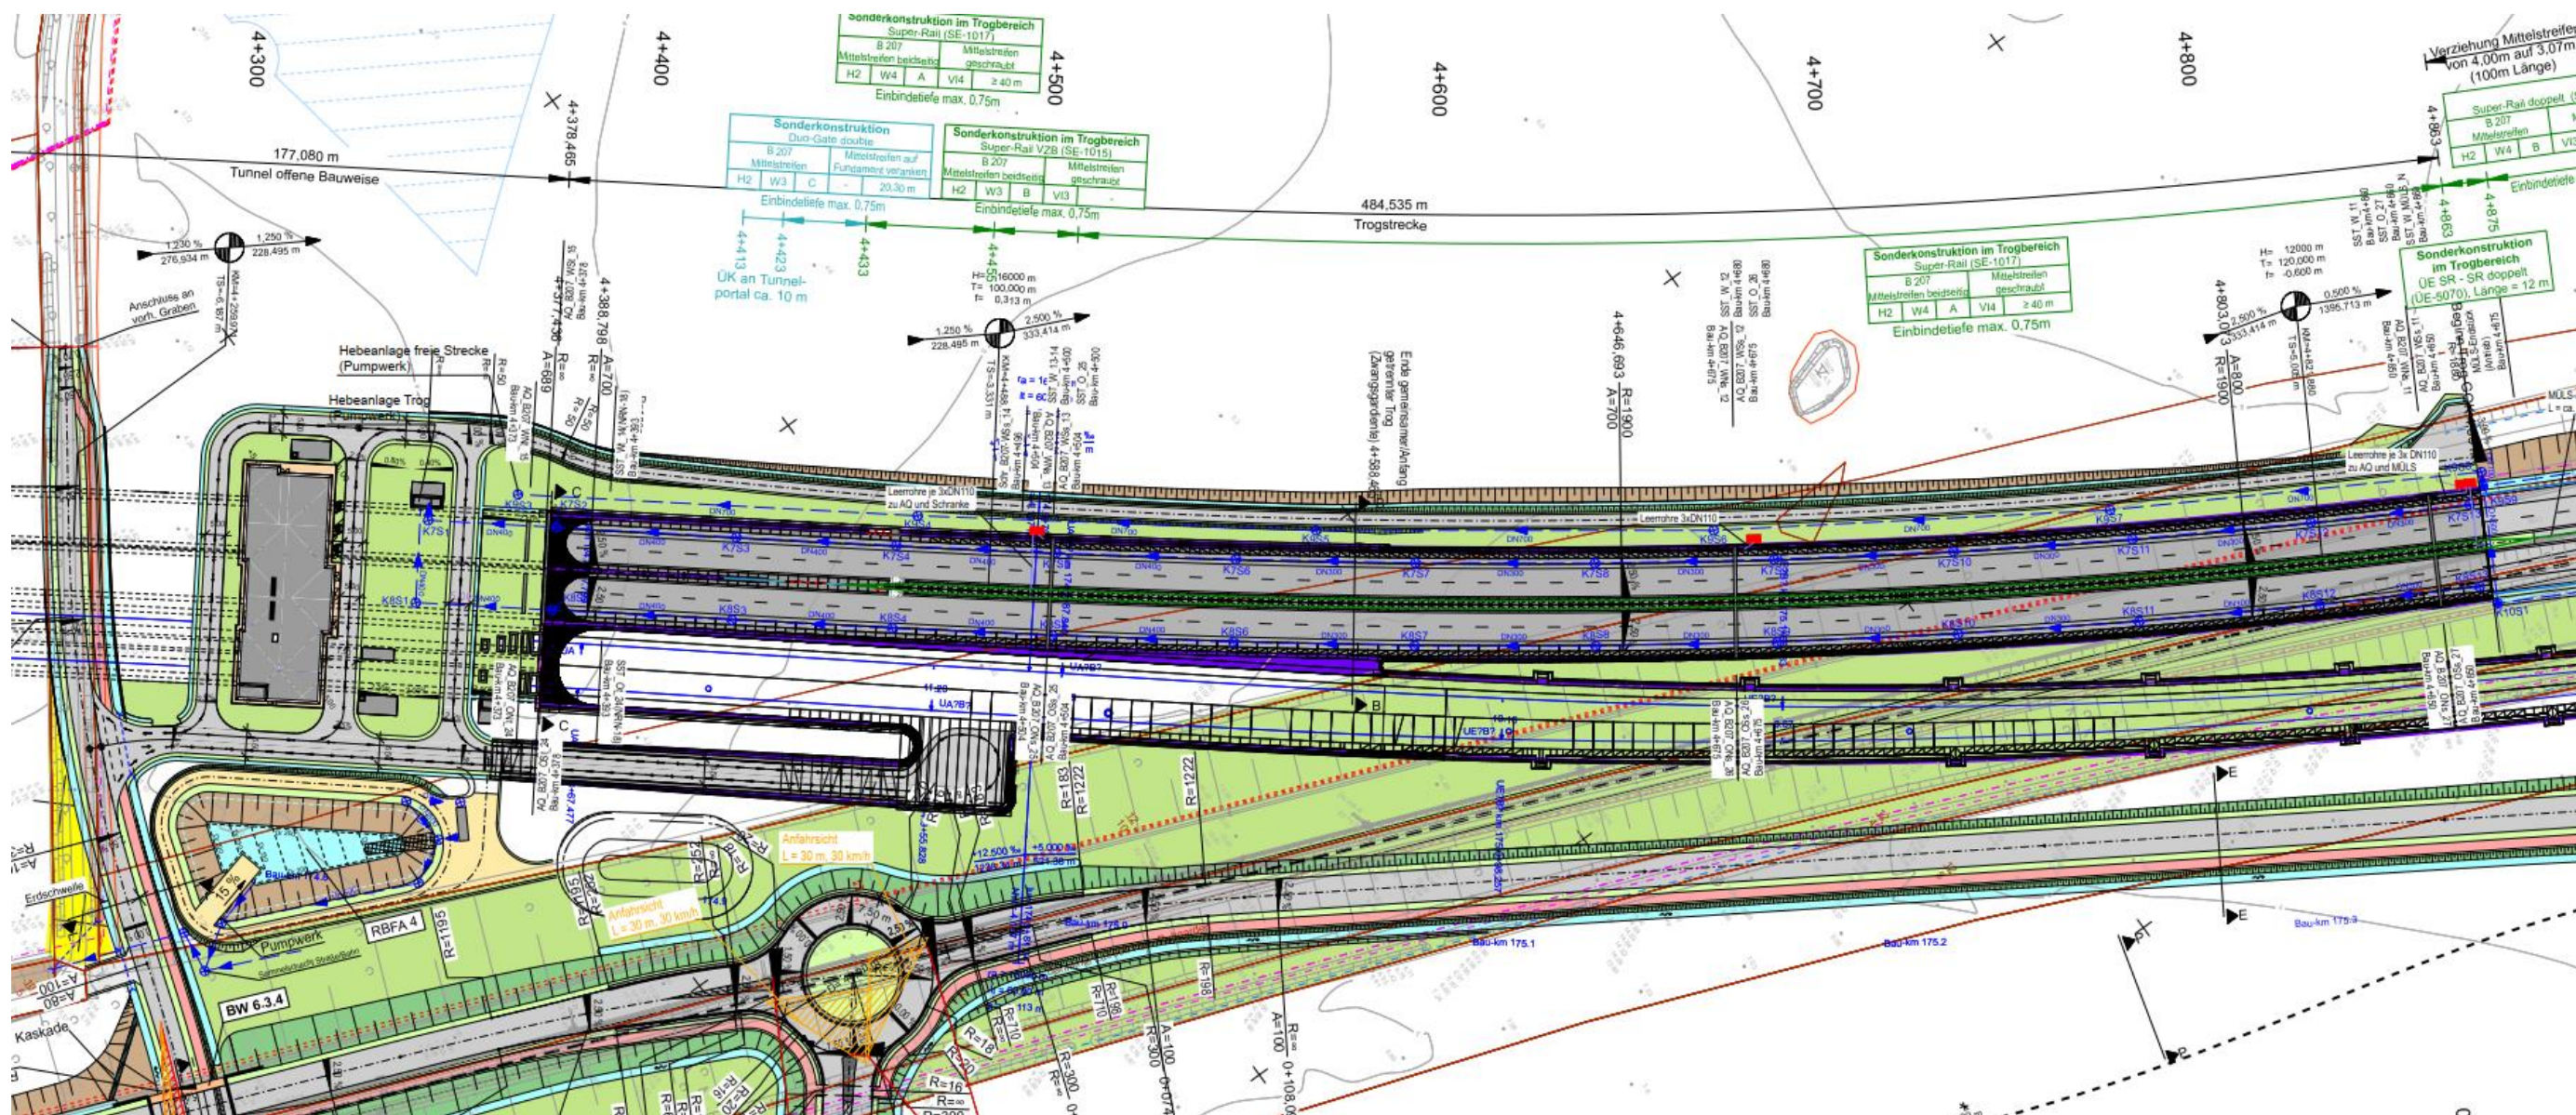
Ausschnitt Lageplan 6 Nord Streckenplanung, Stand 13.06.2023 (siehe FBQ_FSQ_0207_99999_VA_2DF_3_P_U05_025505)
